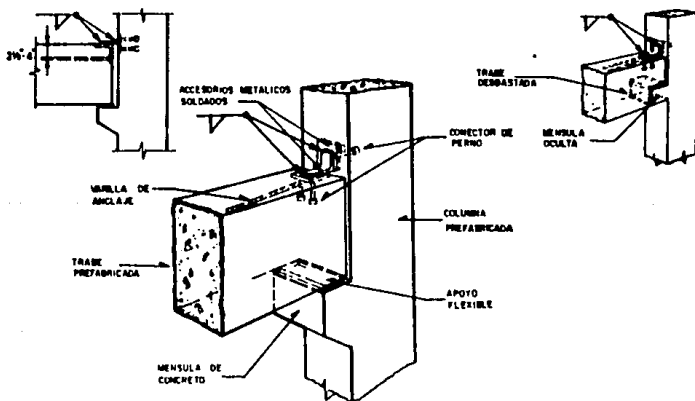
Conexión soldada para extremos articulados.
